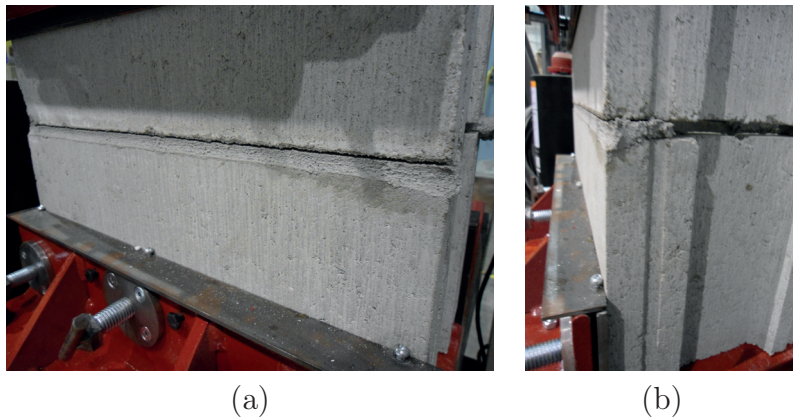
Rupture du joint de mortier d'un prisme lors d'un essai en compression excentrique (a) vue de la façade avant du prisme (b) vue de côté du prisme
